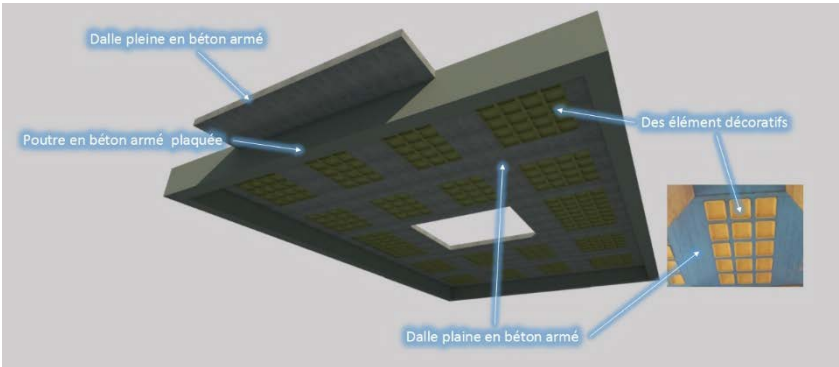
le plancher qui couvre le RDC (dalle pleine)
